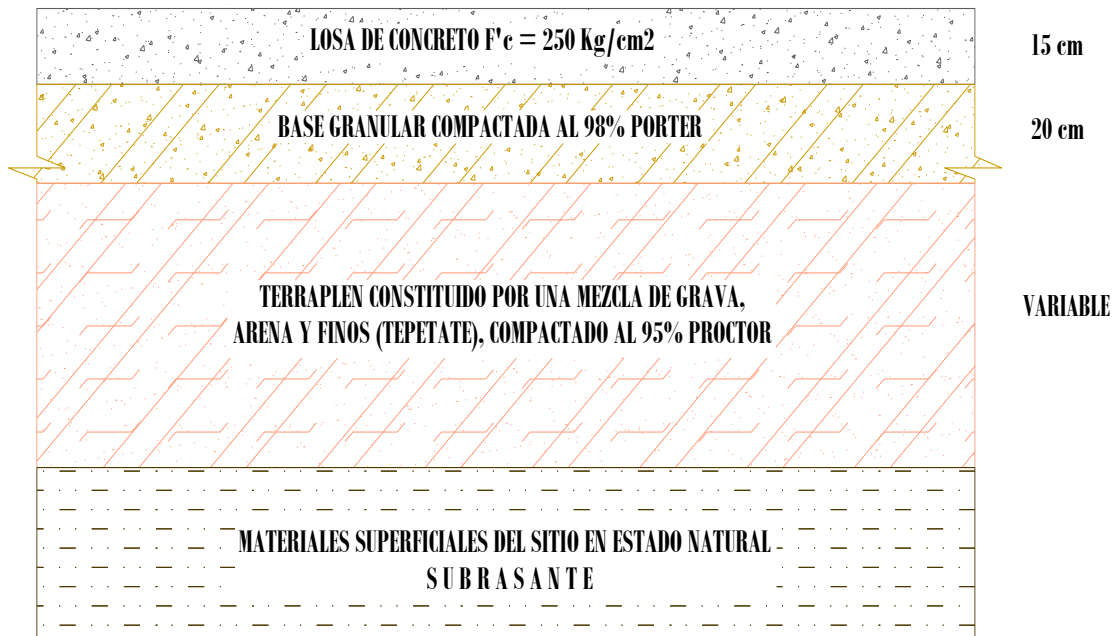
SECCIÓN ESTRUCTURAL DE PAVIMENTOS RÍGIDOS
